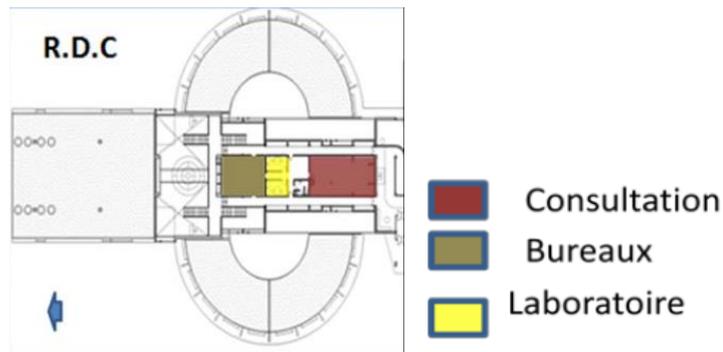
47: Plan R.D.C de la station thermale (google image modifier par l'auteur 2019)
